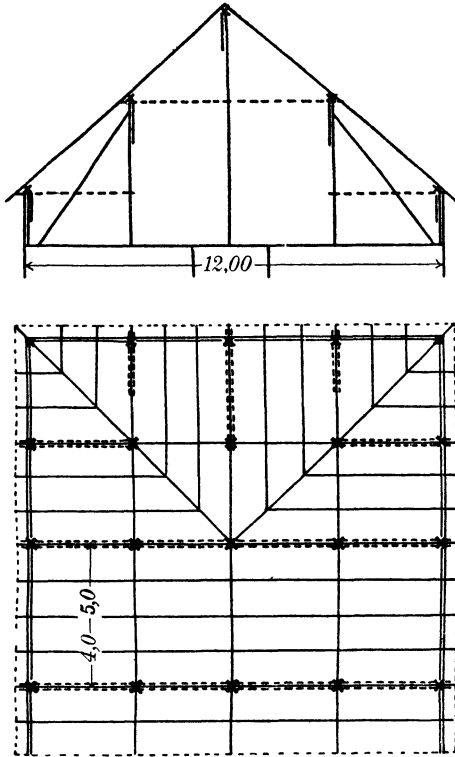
Pfettenwalmdach mit dreifach stehendem Stuhl.
